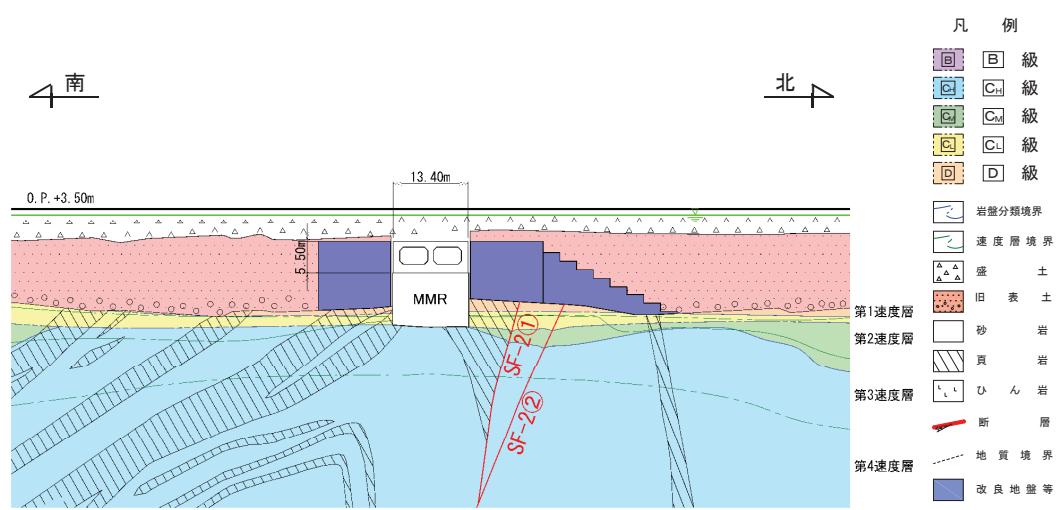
取水路（標準部）地質断面図（断面②：直線部）
